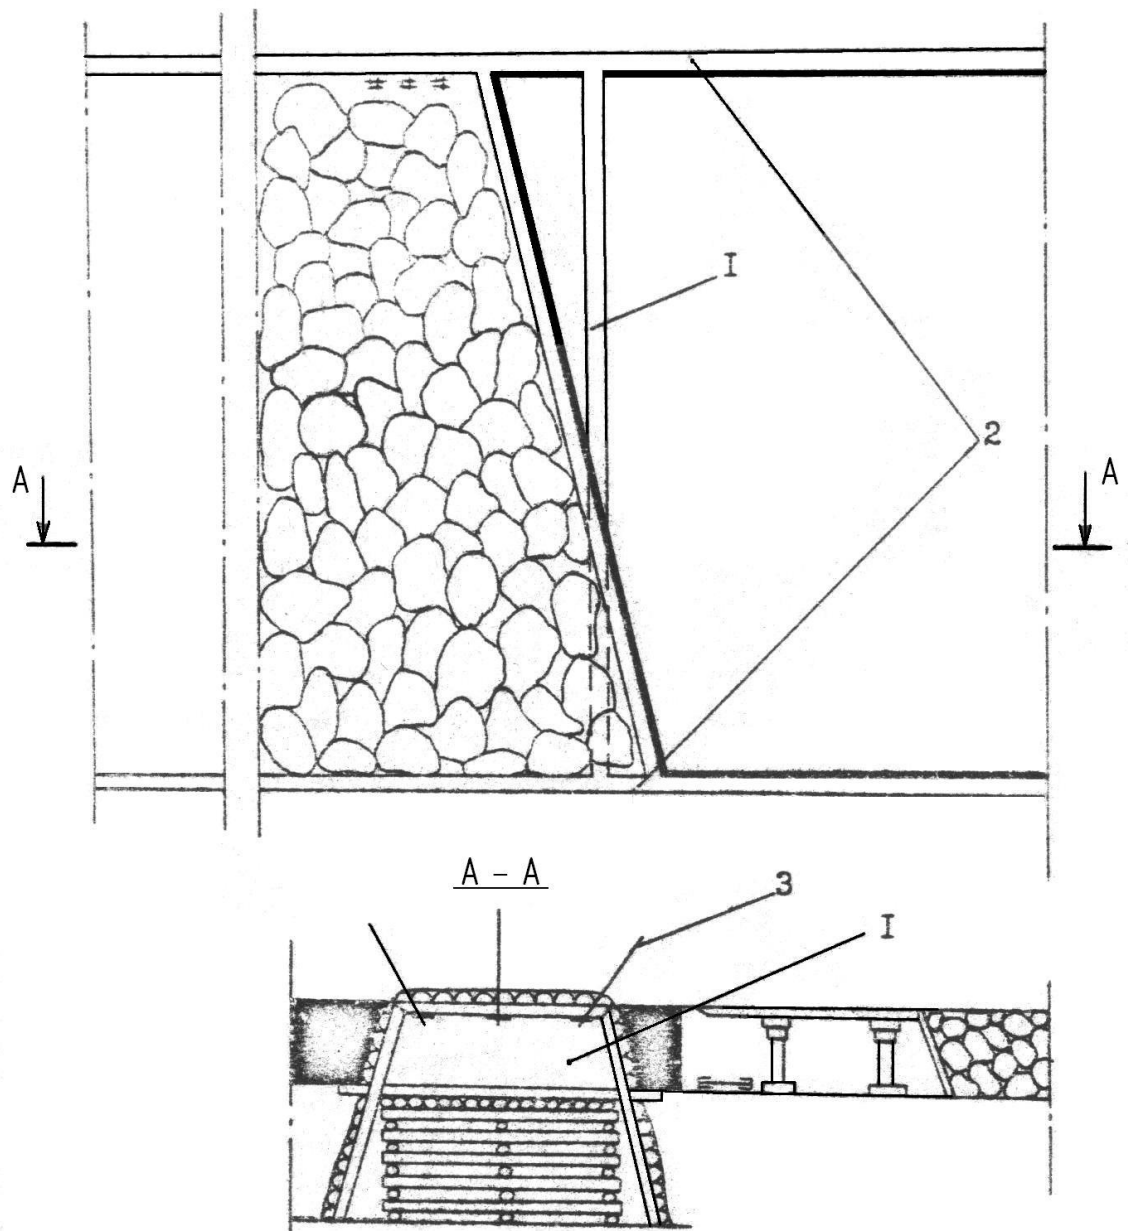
Схема перехода лавой выработки, пройденной с подрывкой почвы пласта:
